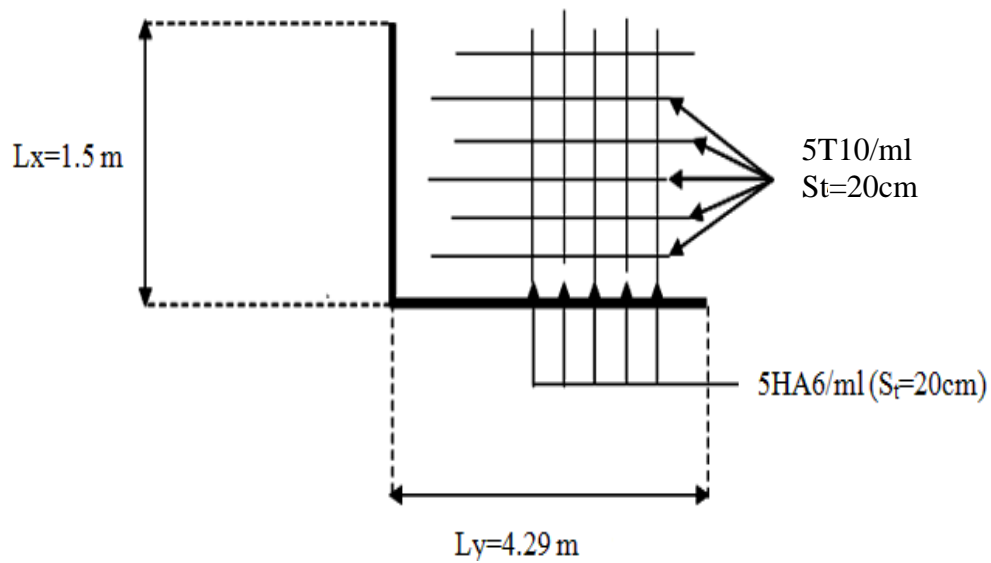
Schéma de ferrailage de la dalle sur deux appuis
